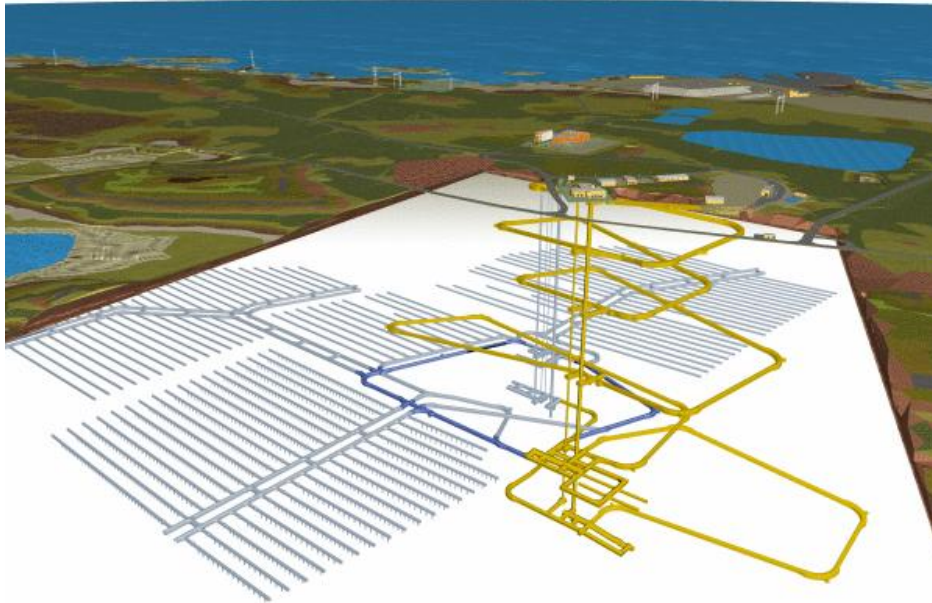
Endlager Olkiluoto -Schematisches Layout – Finnland /2-12/
